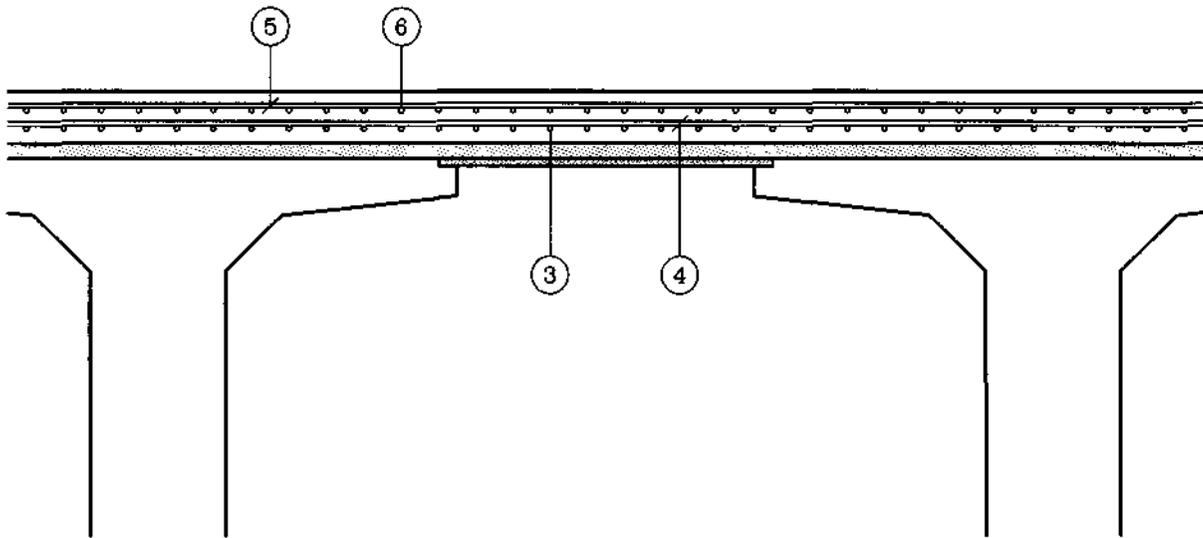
Ferrailage des dalles : Coupe transversale selon AA
